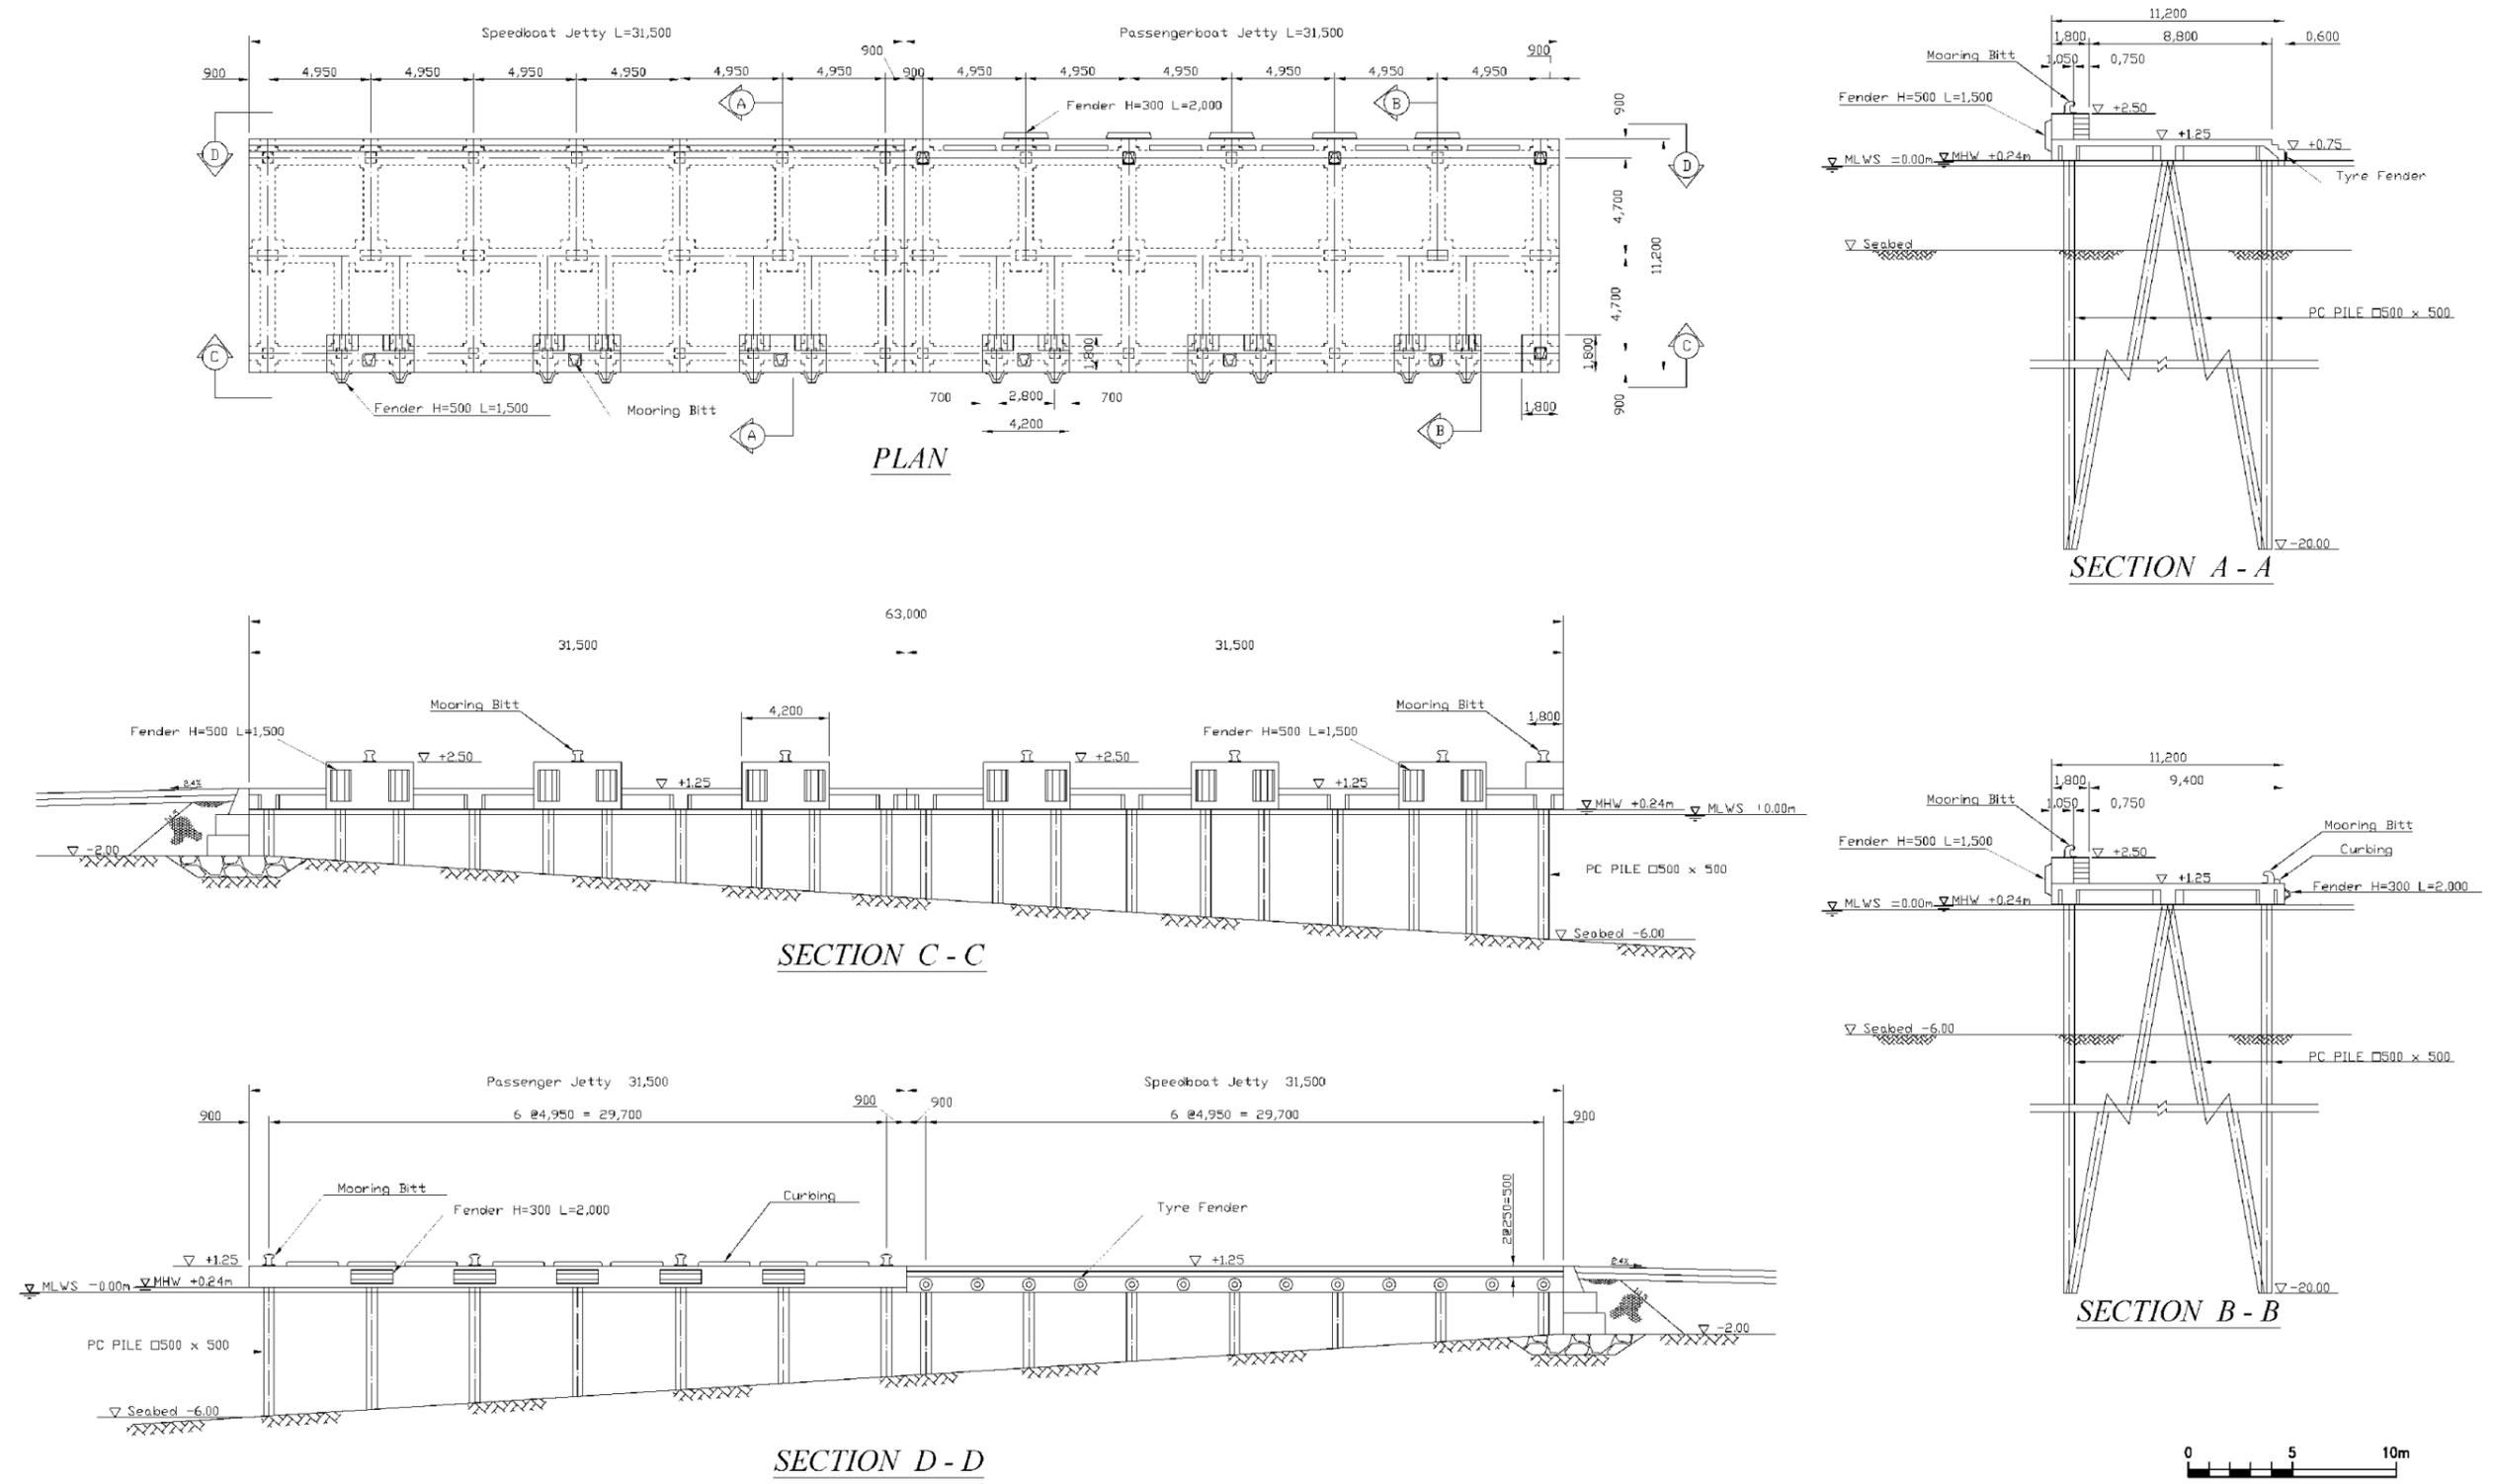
Plan Típico y Sección de Pared de Muelle
